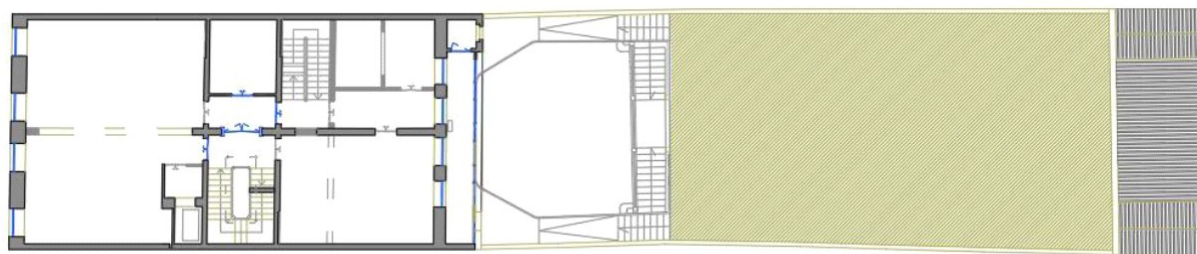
Planta de arquitetura original do piso 2 (sem escala)
